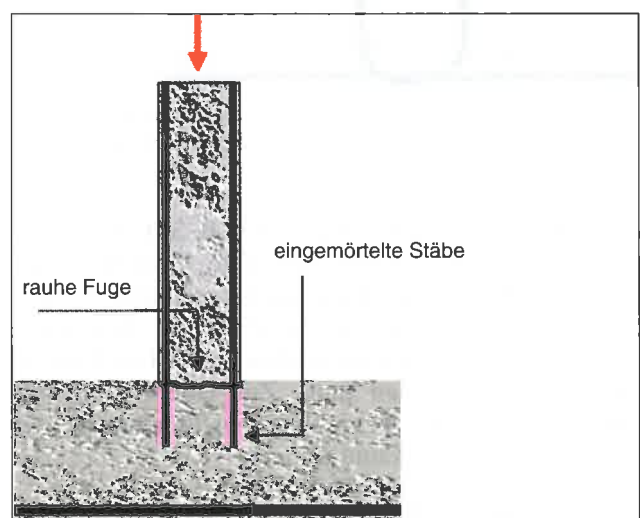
Anschluss einer Stahlbetonstütze an ein Fundament ohne Anschlussbewehrung. Einleitung einer Druckkraft. Bewehrungsanschluss zulässig
